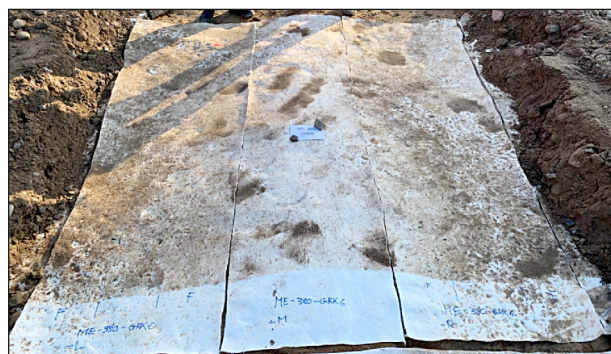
Beispiel für Probenbezeichnungen im Versuchsfeld VF GRK6
